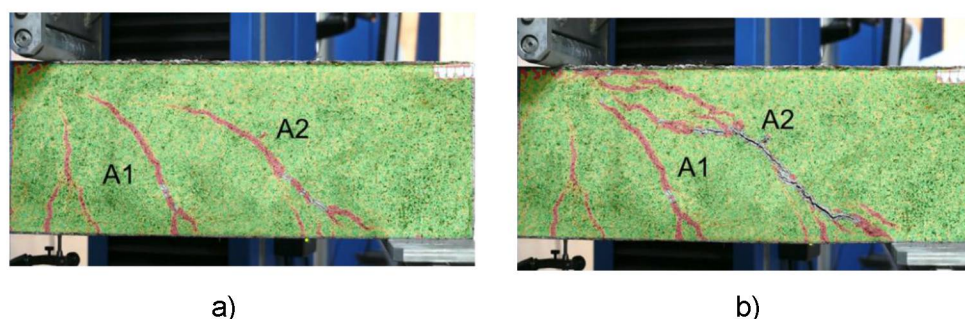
Viga V102 no instante da a) ruptura e b) falha instável
